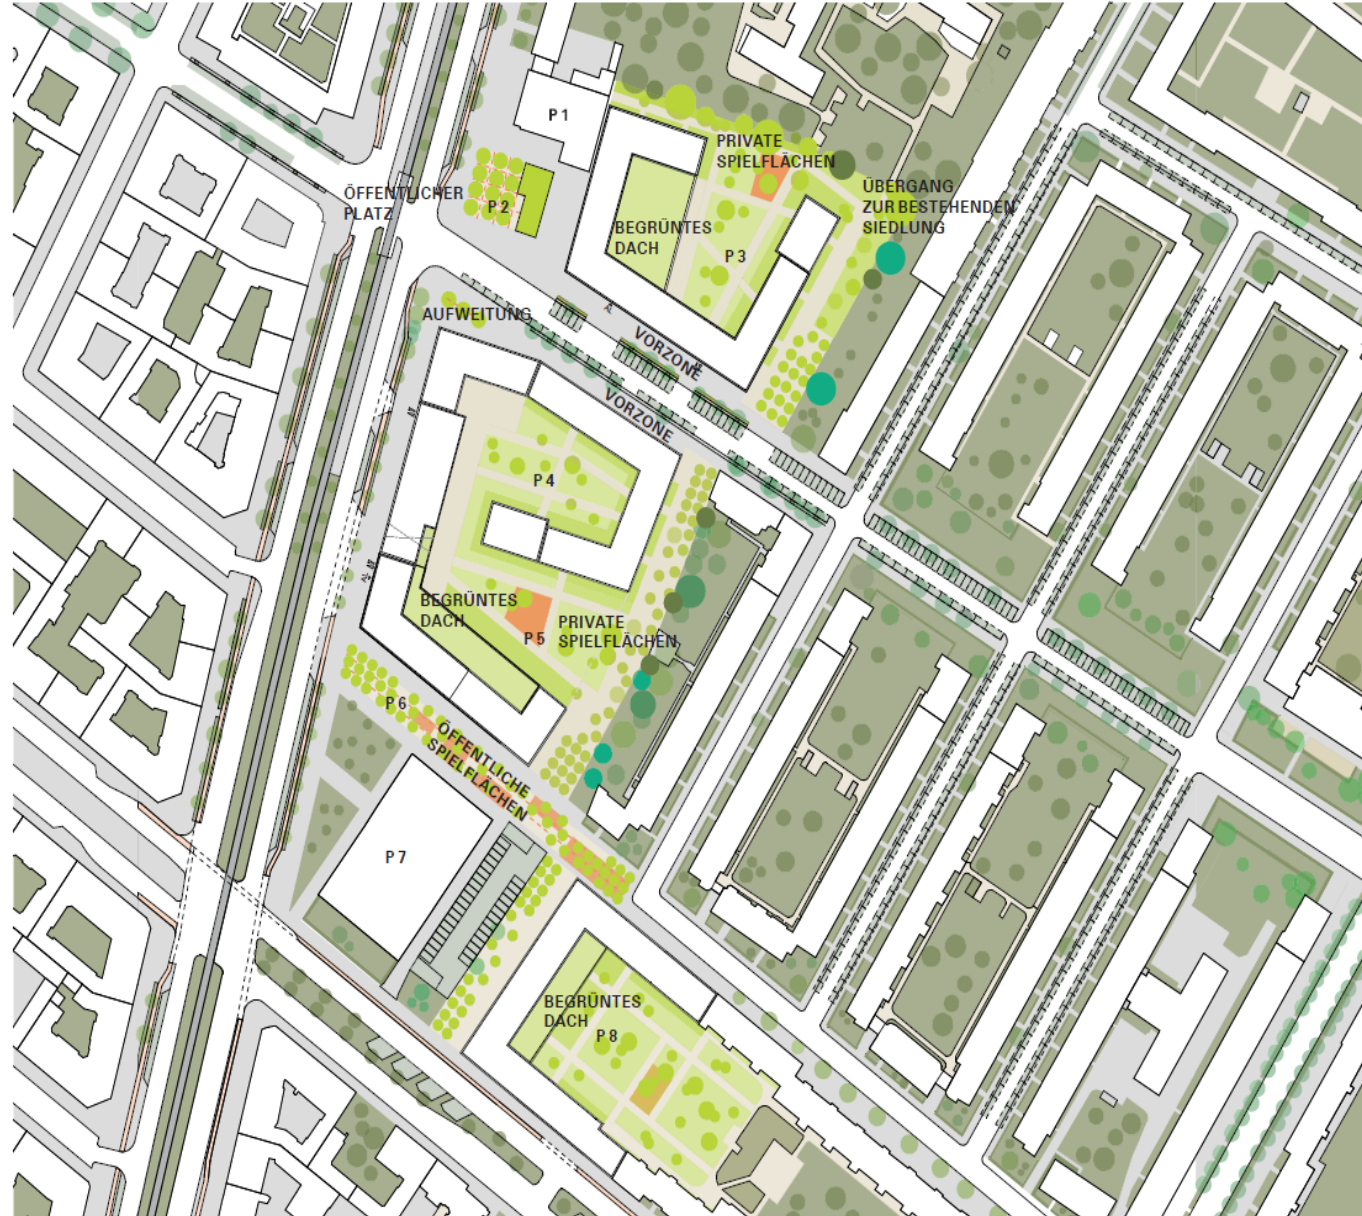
Variante A, Lageplan, Endfassung, o. M.
